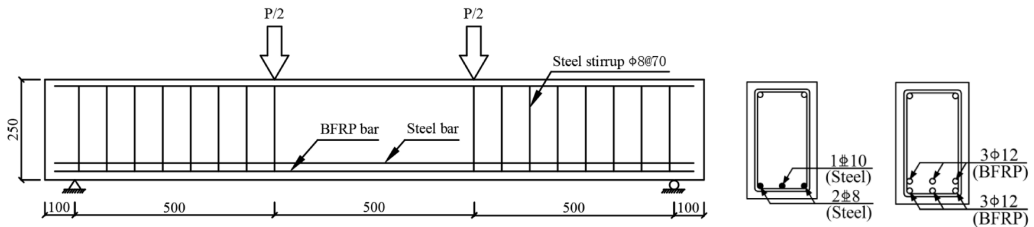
Abmessungen und Bewehrung der Biegebalken aus [46]. Querschnitt der Biegebalken mit verschiedenen Stahl- und Basaltfaser-Bewehrungsgehalten.
